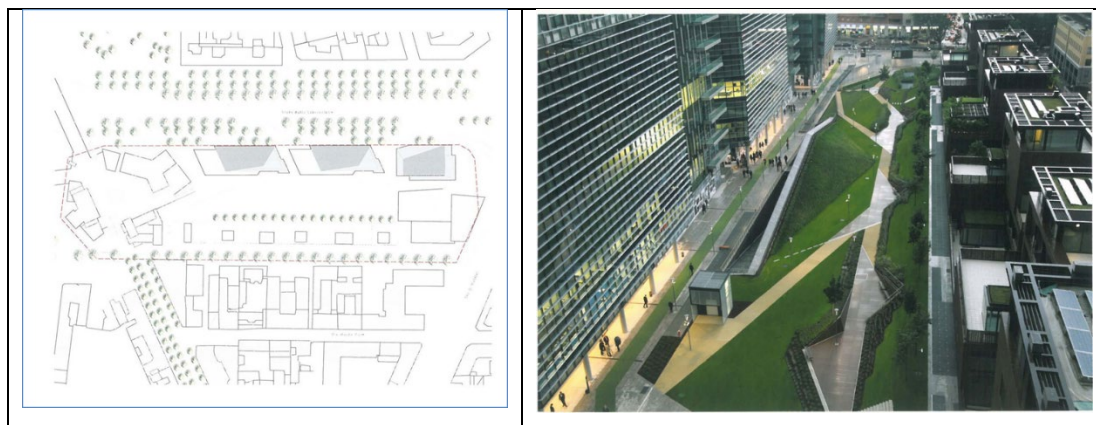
Planimetria e vista di Porta Nuova Varesine
